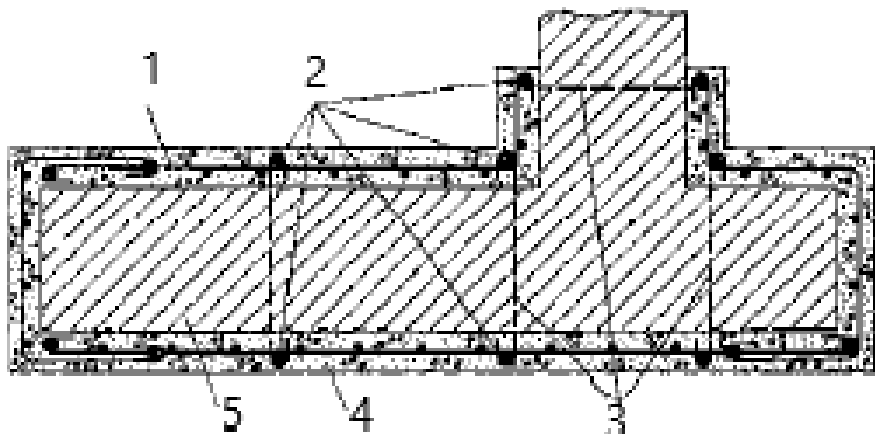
Схема усиления каменной стены железобетонной обоймой, где: 1 — металлическая сетка; 2 — дополнительные стержни; 3 — хомуты (связи); 4 — бетон обоймы; 5 — кладка стены
